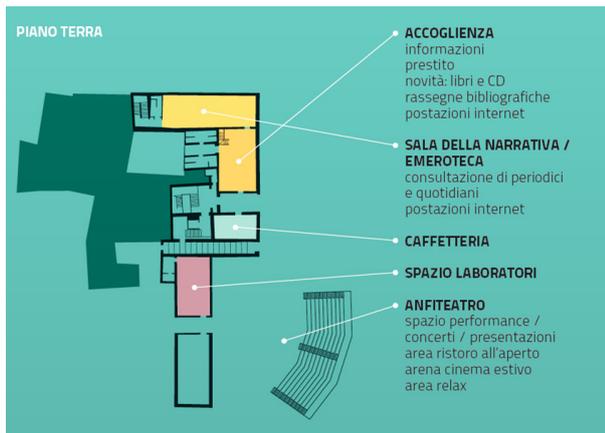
Planimetria Biblioteca della Ginestra (Piano terra)
